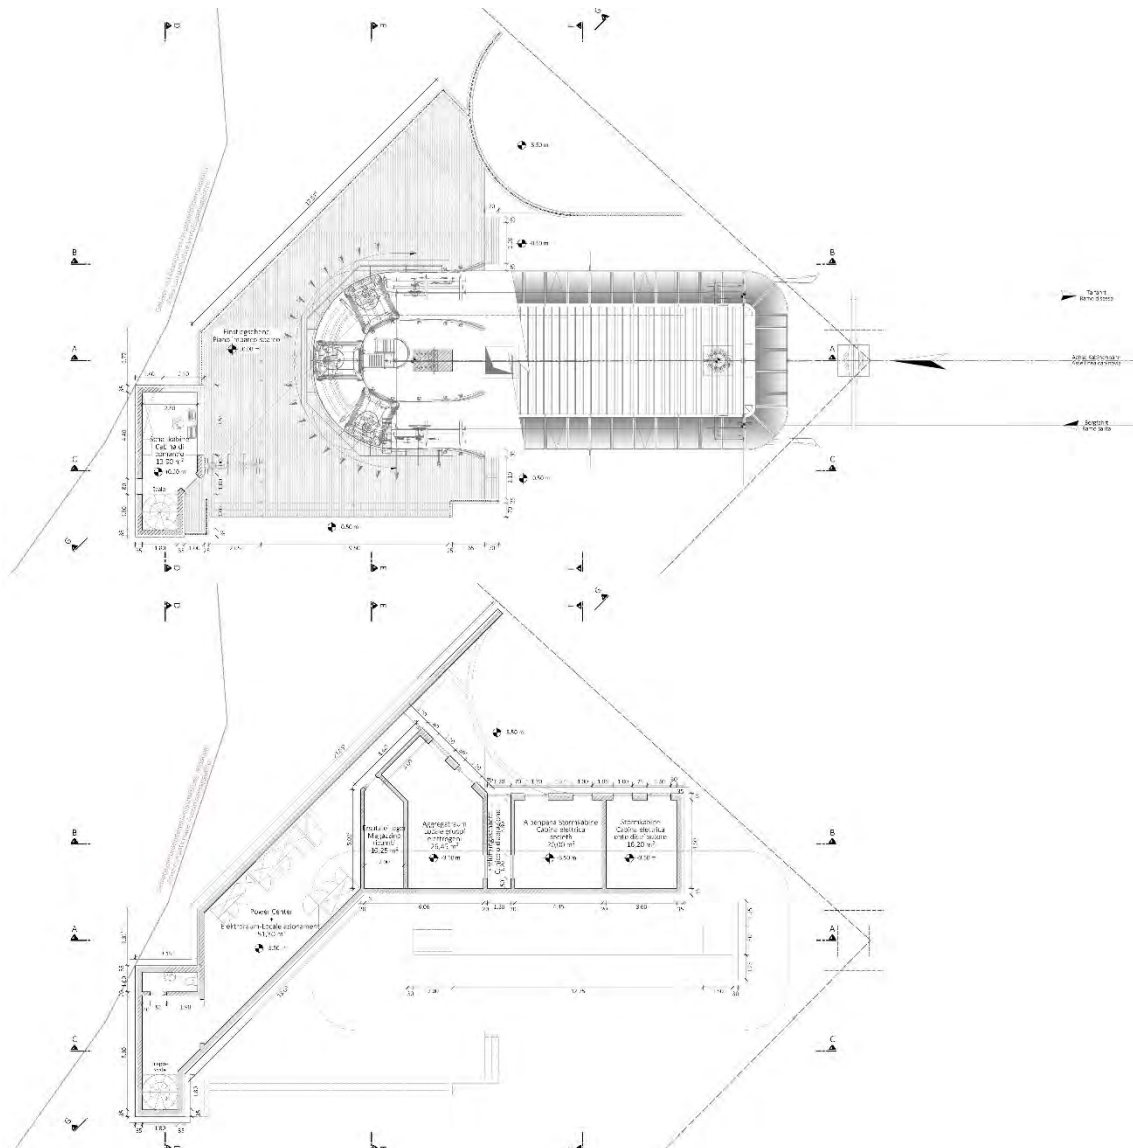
| Pianta del piano d'imbarco e del piano interrato della stazione di monte
